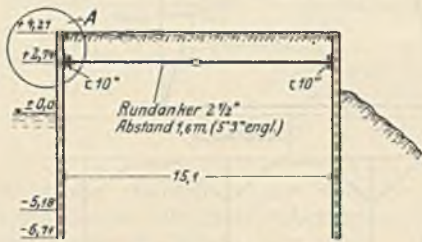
Schnitt a—a durch den Hauptfangedamm.
